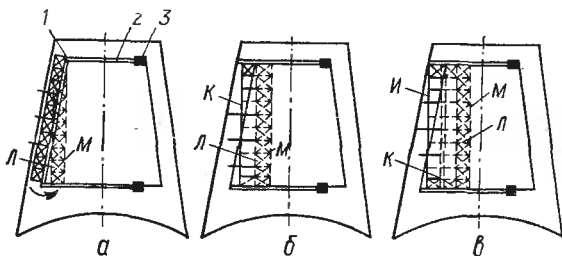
Схема монтажа и надвигки металлоконструкций покрытия:
